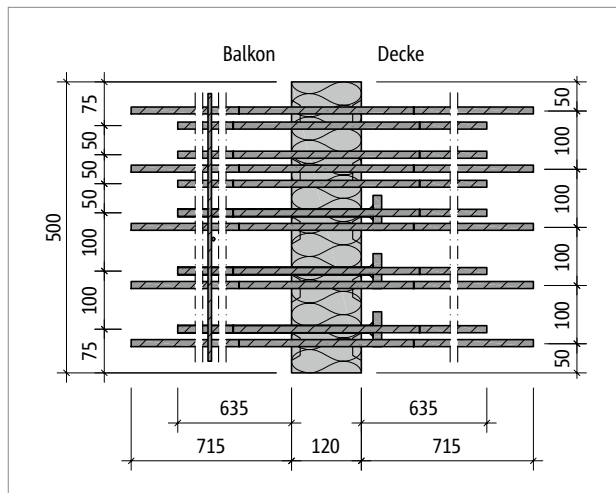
Schöck Isokorb® XT Typ CL-L-M2-V2: Produktgrundriss
